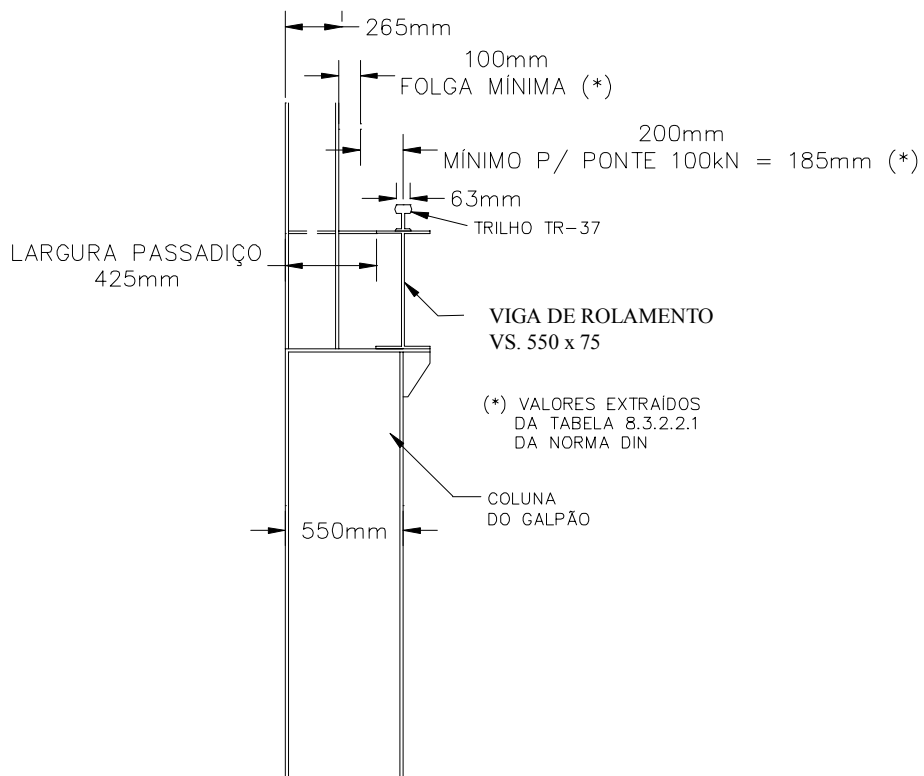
Detalhe da montagem da viga de rolamento sobre a coluna do galpão.
